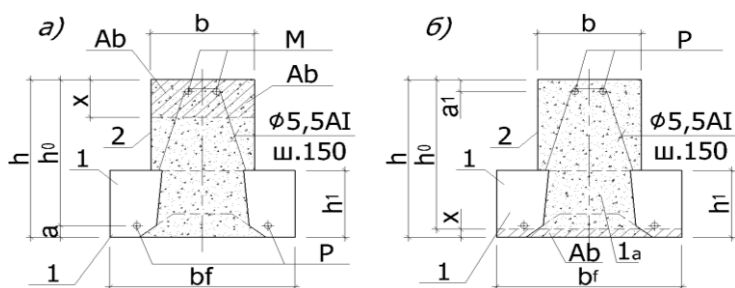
Расчетное сечение *СбМт* пояса внутренних стен в пролете (а) и над опорой (б): 1-опорная ветвьбалка; 1а – ж.б. перемычки, ш.400; 2 - монолитный сердечник; P – растянутая рабочая арматура (2Ø16Ат420); M - монтажная арматура (2Ø5,5А1); A_b - сжатая зона бетона; $h=400$;
